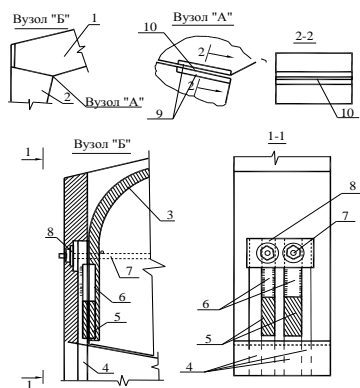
Беззварний вузол з'єднання ригеля зі стояком:
